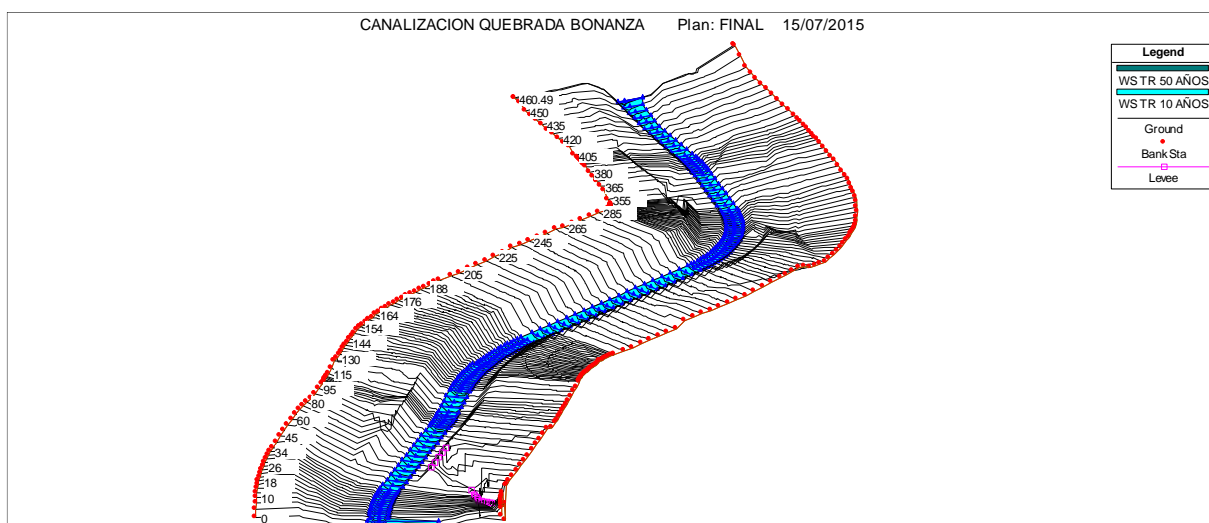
Vista 3D (XYZ) del Canal Propuesto
